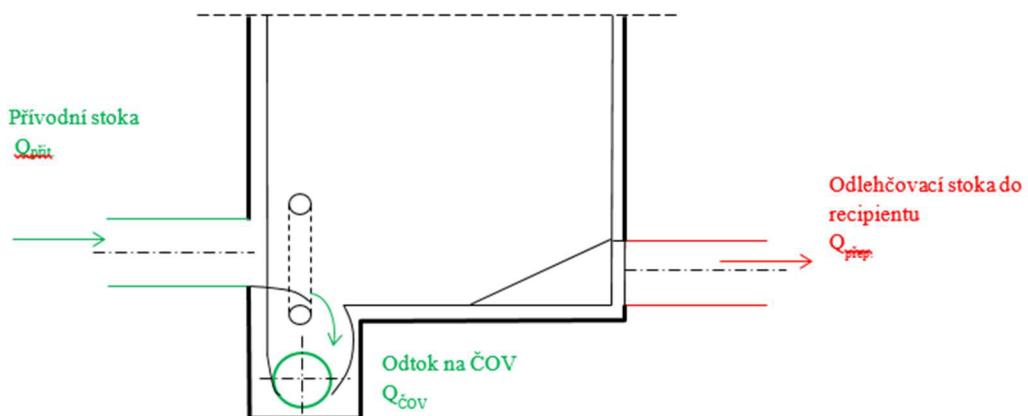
Odlehčovací komora s přepadem bočním oboustranným se šikmou hranou
